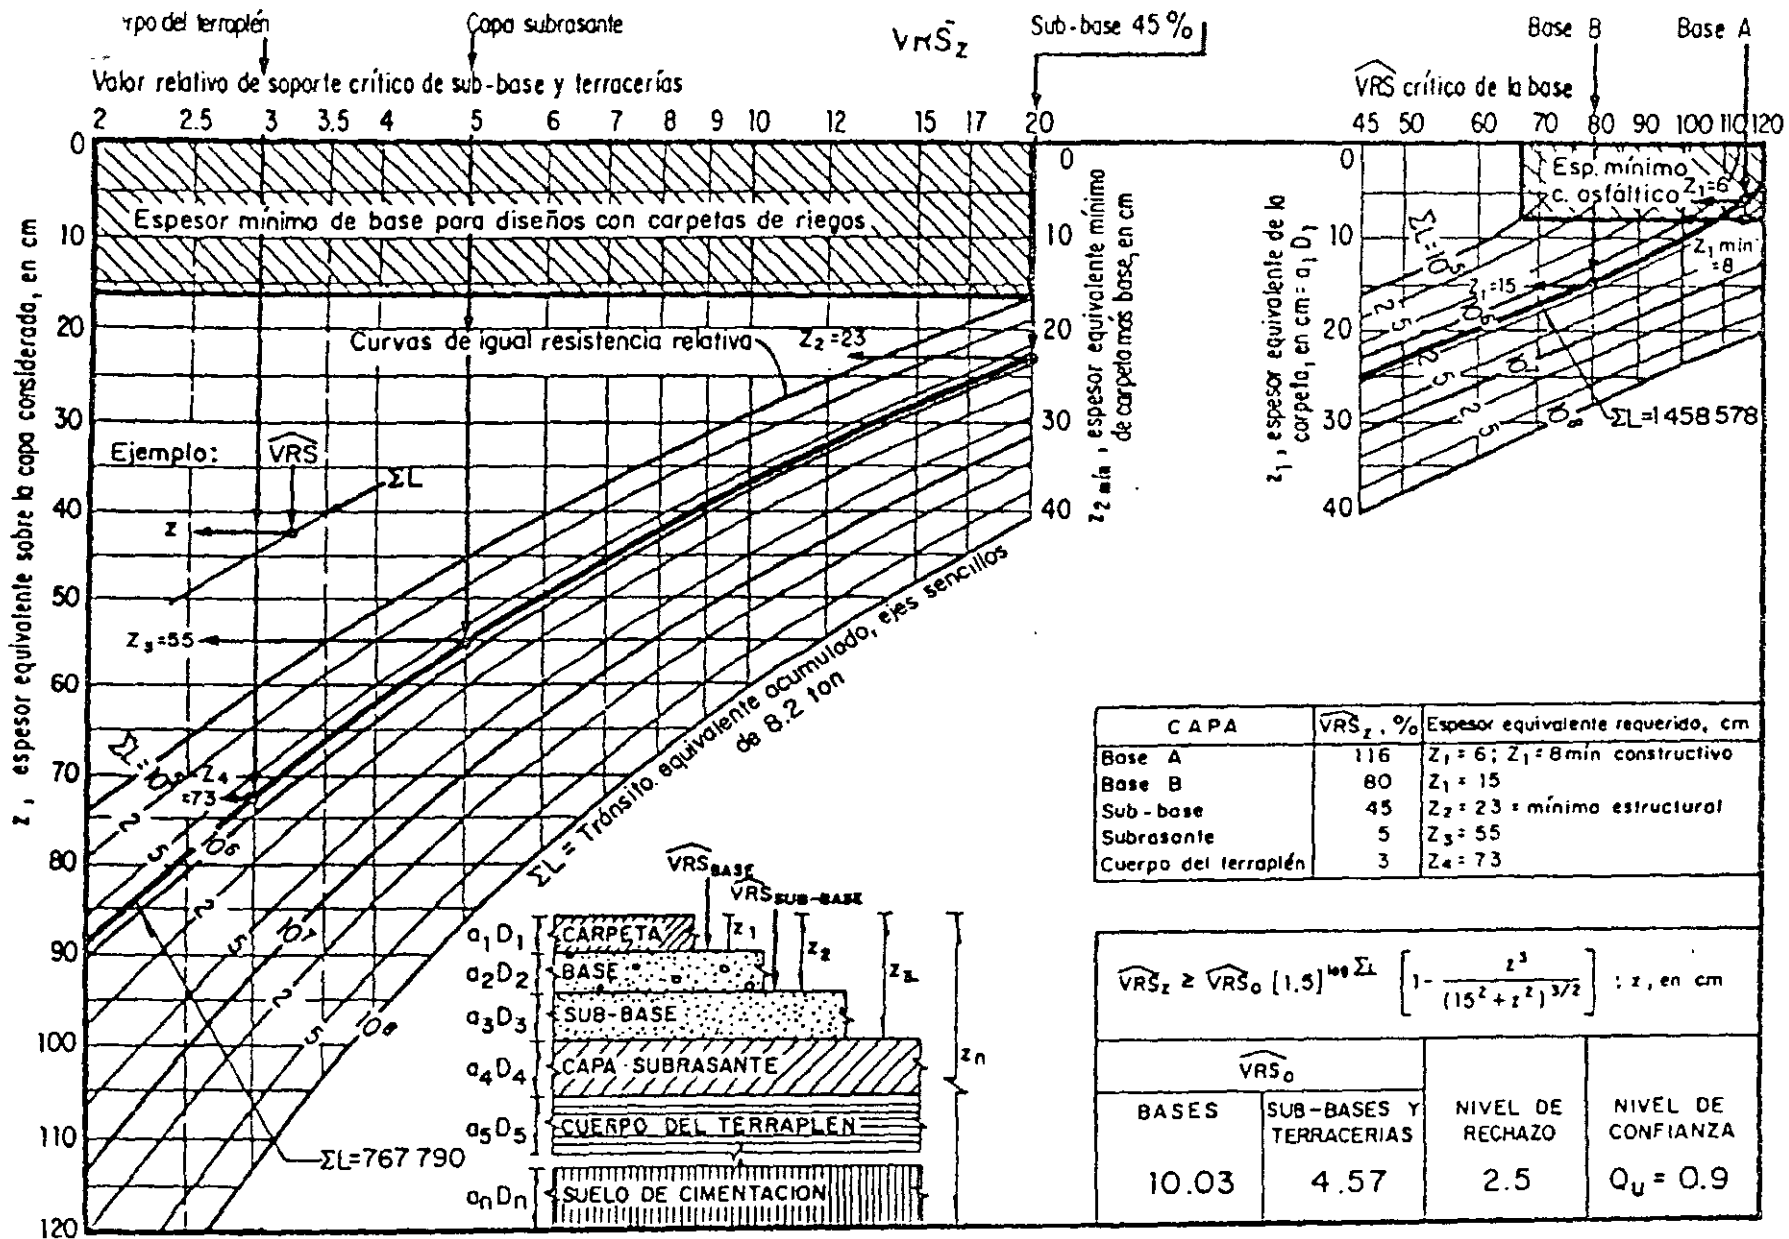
Ejemplo: gráfica para diseño estructural de carreteras con pavimento flexible
